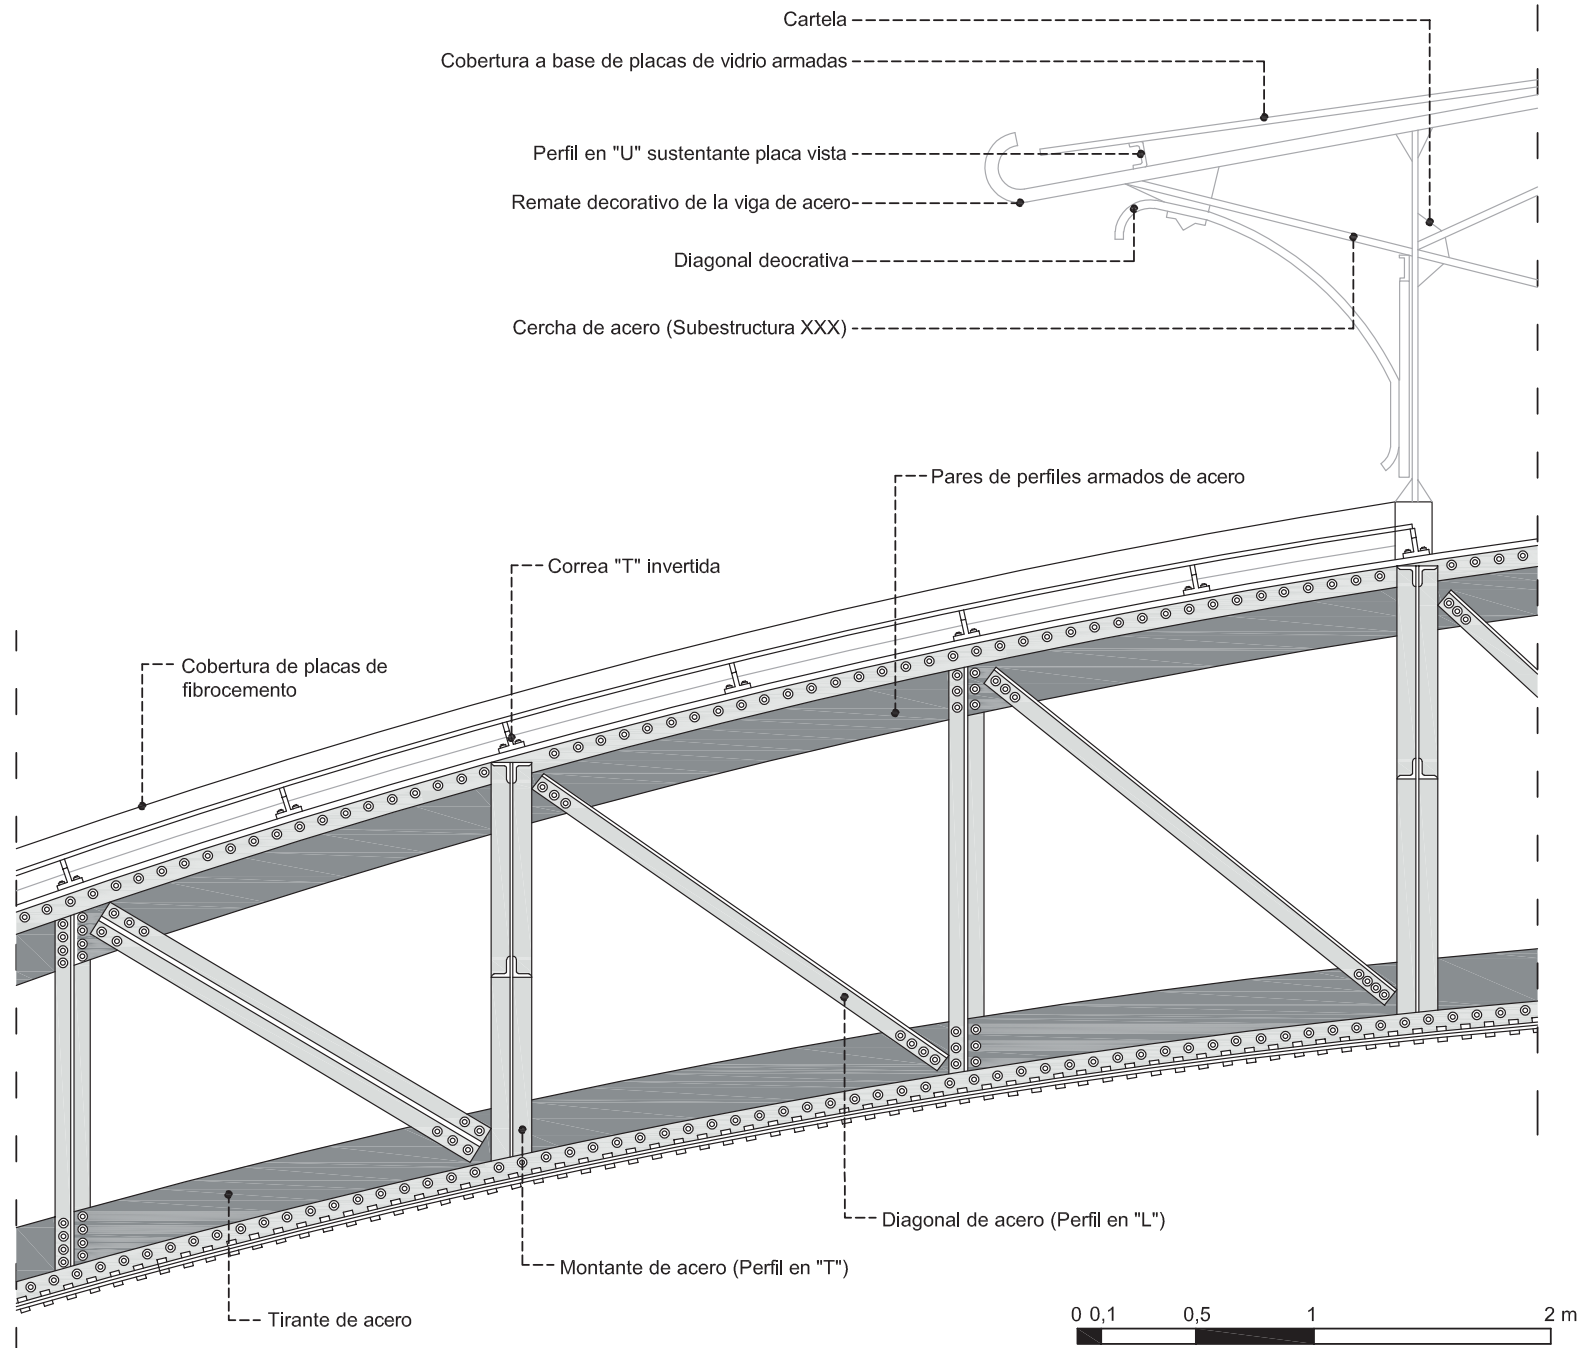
Detalle constructivo encuentro lucernario arco abovedado
